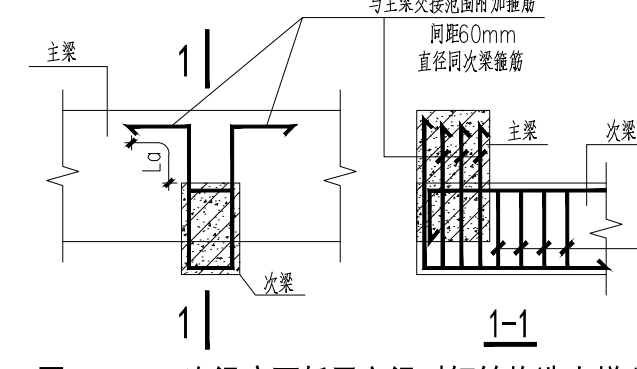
次梁底面低于主梁时钢筋构造大样(一)
